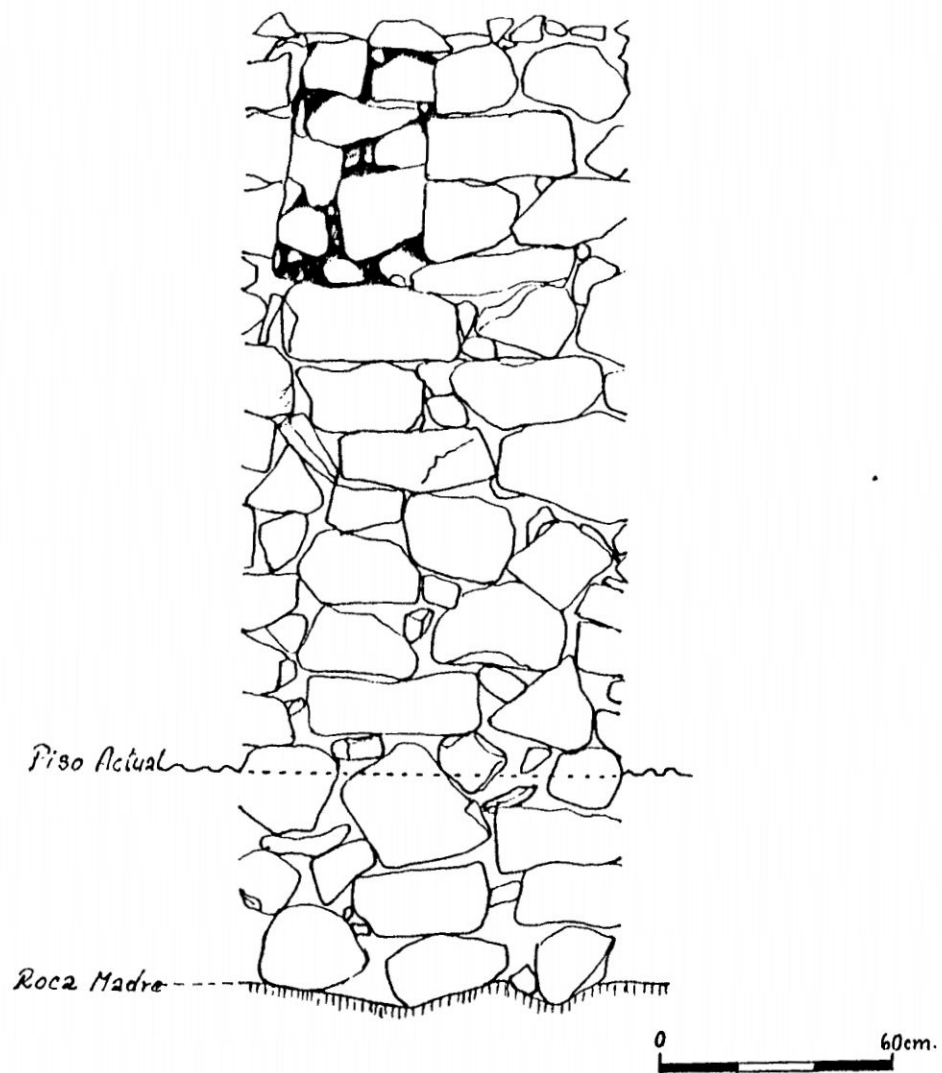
SONDOR, MURO INTERIOR SURESTE DONDE SE PUEDE APRECIAR LA MAMPOSTERIA Y EL DETALLE DE UNA DE LAS HORNACINAS.
